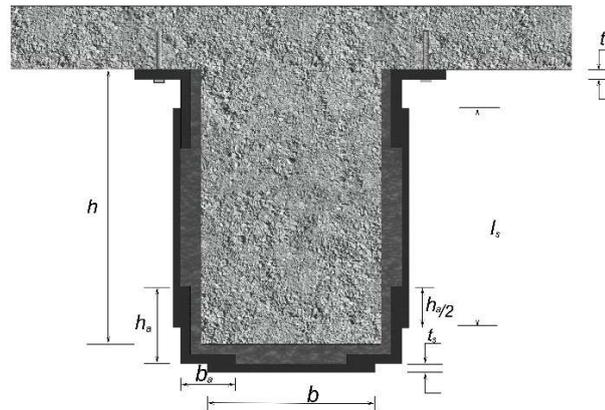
a - Sección transversal de viga encamisada con ángulos y soleras
